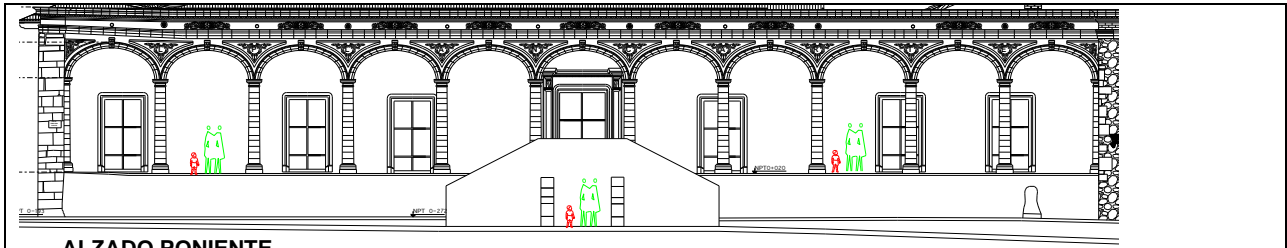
Vista principal donde se aprecia la arcada de la fachada poniente.
